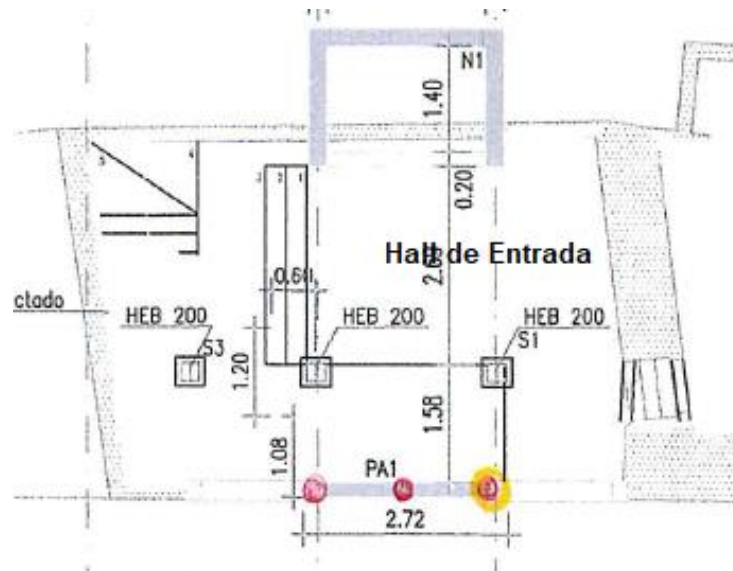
Projeto de Alteração Parede Estrutural PA1
